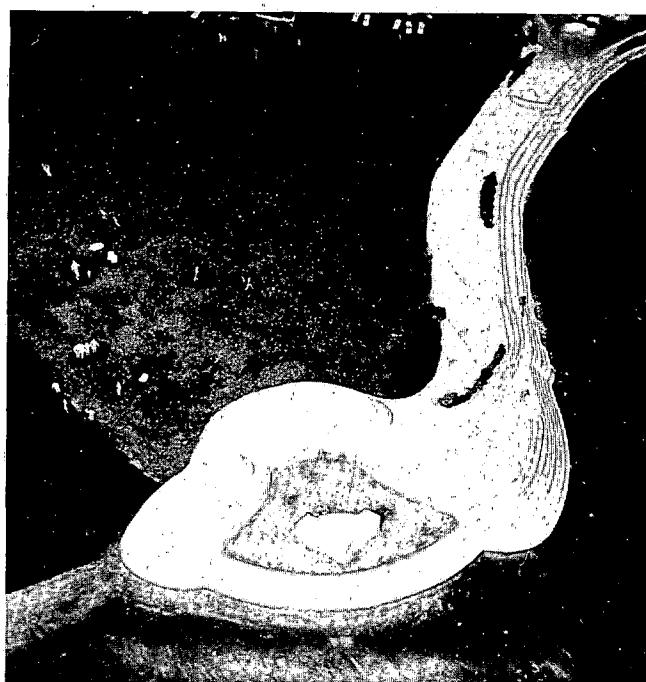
Proyecto de Playa Honda: Espigón Sur (marea baja viva); maqueta.
